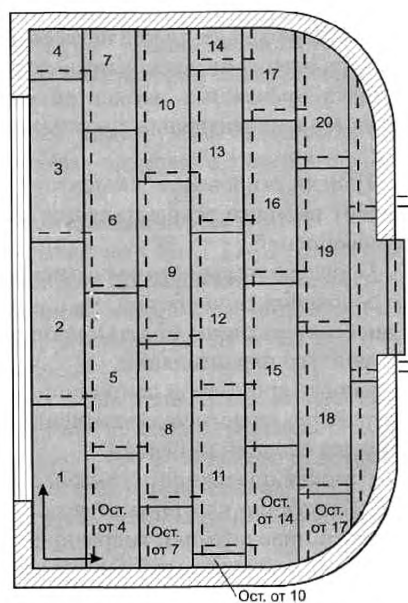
Укладка элементов пола от стены, противоположной стене с дверным проемом.
